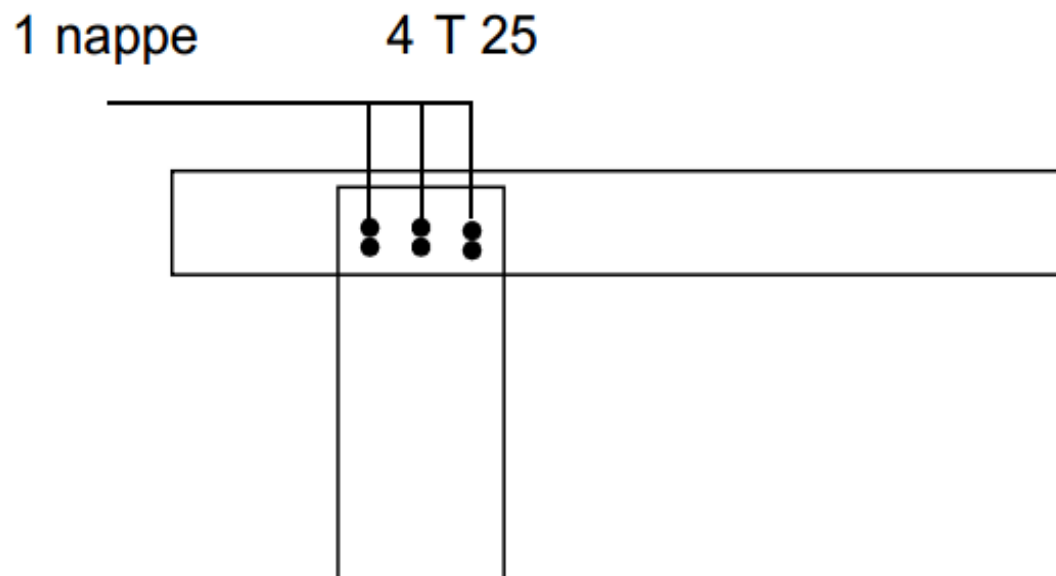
ferrailage de l'entretoise (nappe sup).
